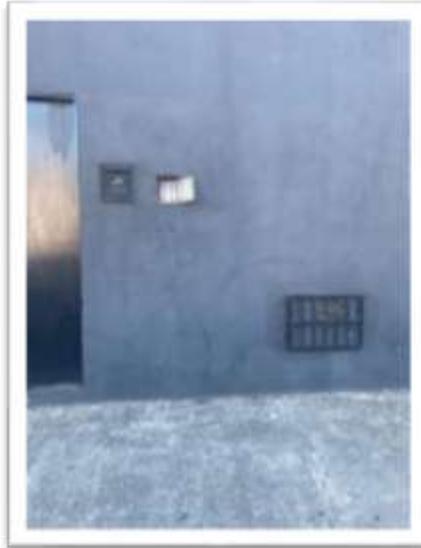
Entrada cavalete sabesp –Arquivo Pessoal
